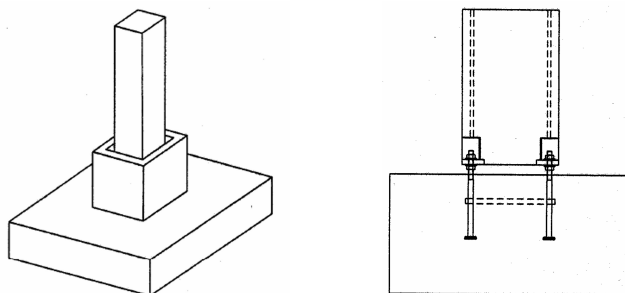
Exemplos de ligação pilar-fundação, com encaixe (esquerda) e aparafusada (direita). Adaptado de [5].
